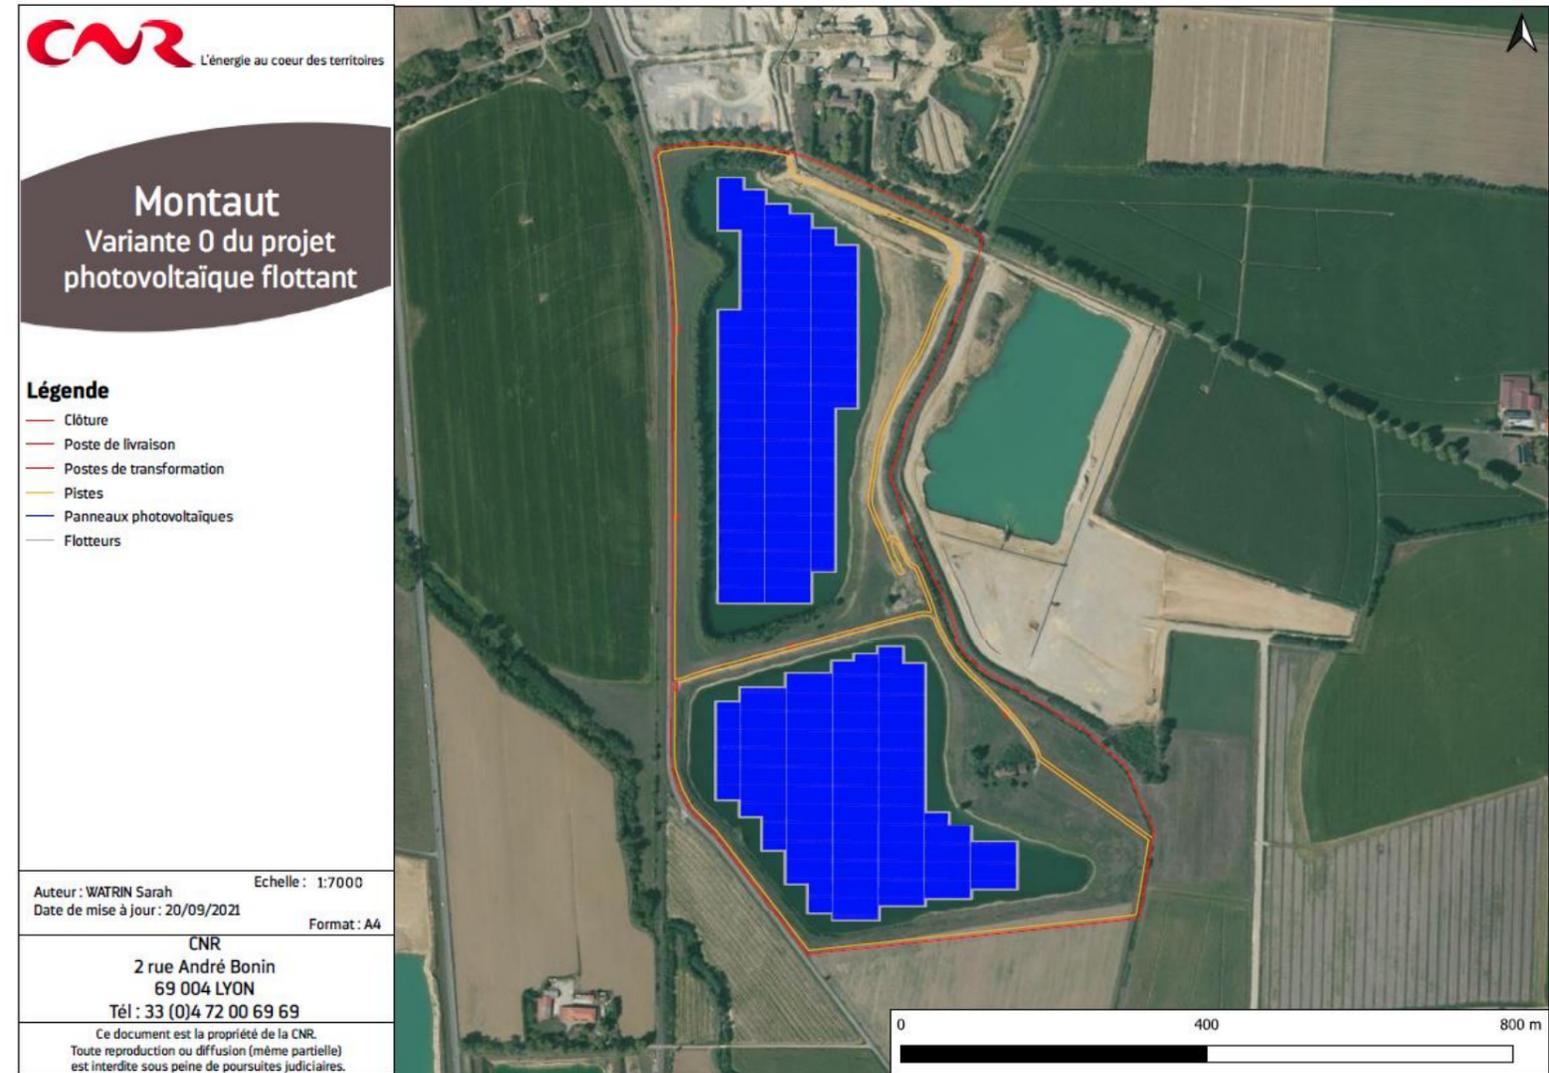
Plan de masse de la variante 0 (septembre 2021)
